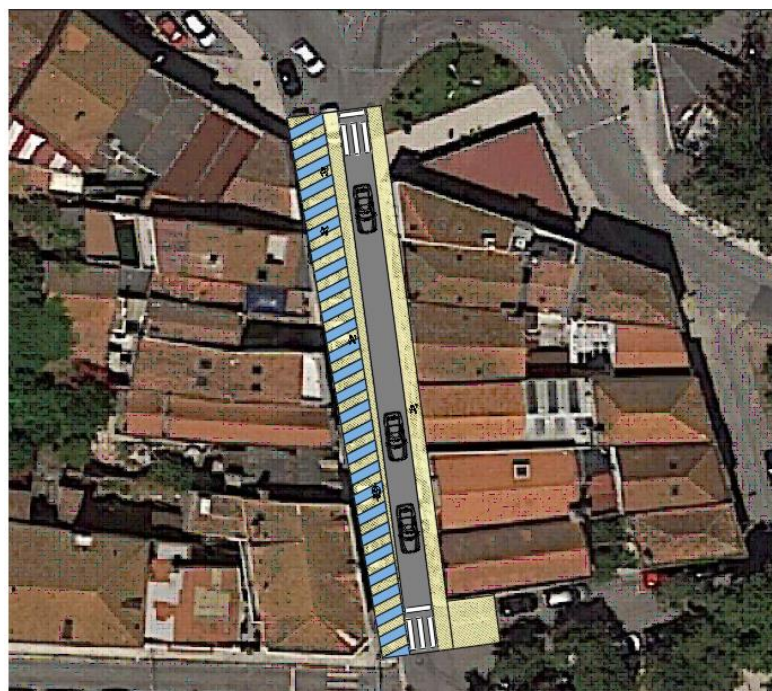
Proposta para reformulação da Rua Praia da Fonte - trecho 6
